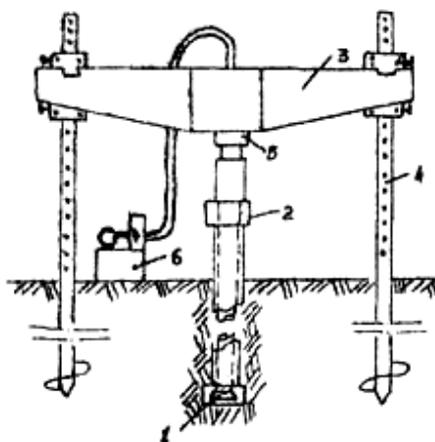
Схема установки для испытания грунтов статическими нагрузками в скважинах: 1 - штамп; 2 - обсадная труба; 3 - упорная балка; 4 - анкерные сваи; 5 - шток домкрата; 6 - маслонасос
